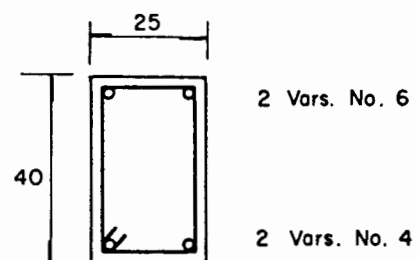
Armado de vigas usando RCDF-87 y Q=4
